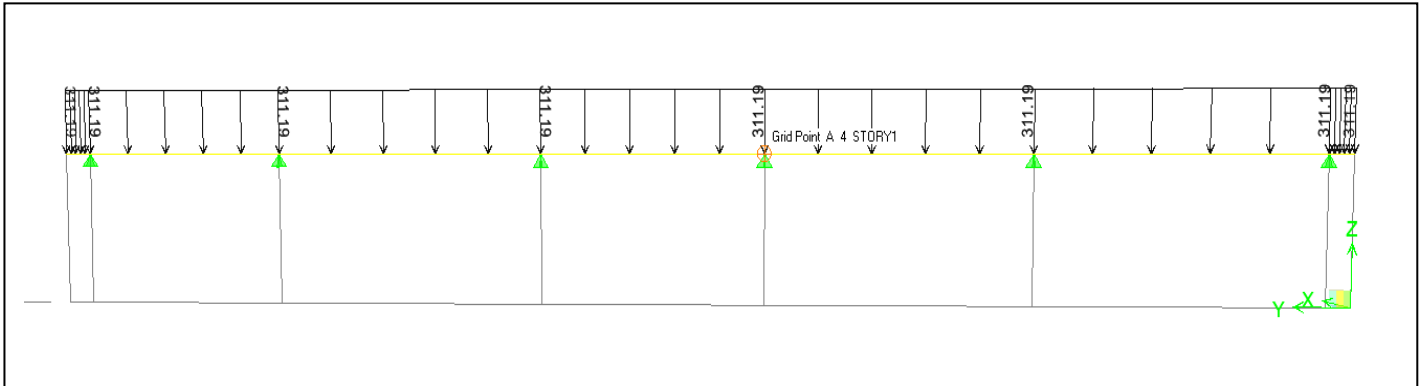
Schéma statique de la nervure ELU (sens transversal).
